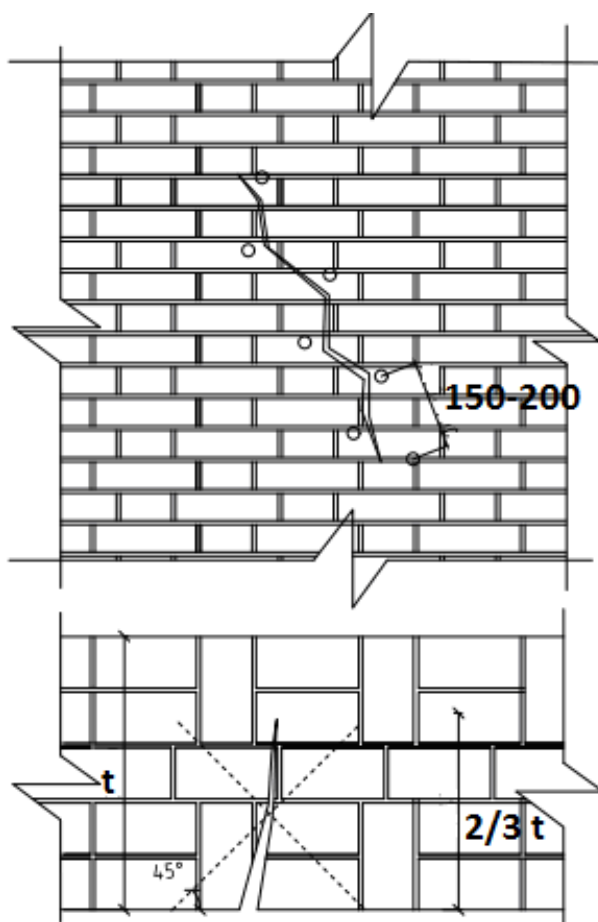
Расположение отверстия для пакеров при ремонте открытых трещин
